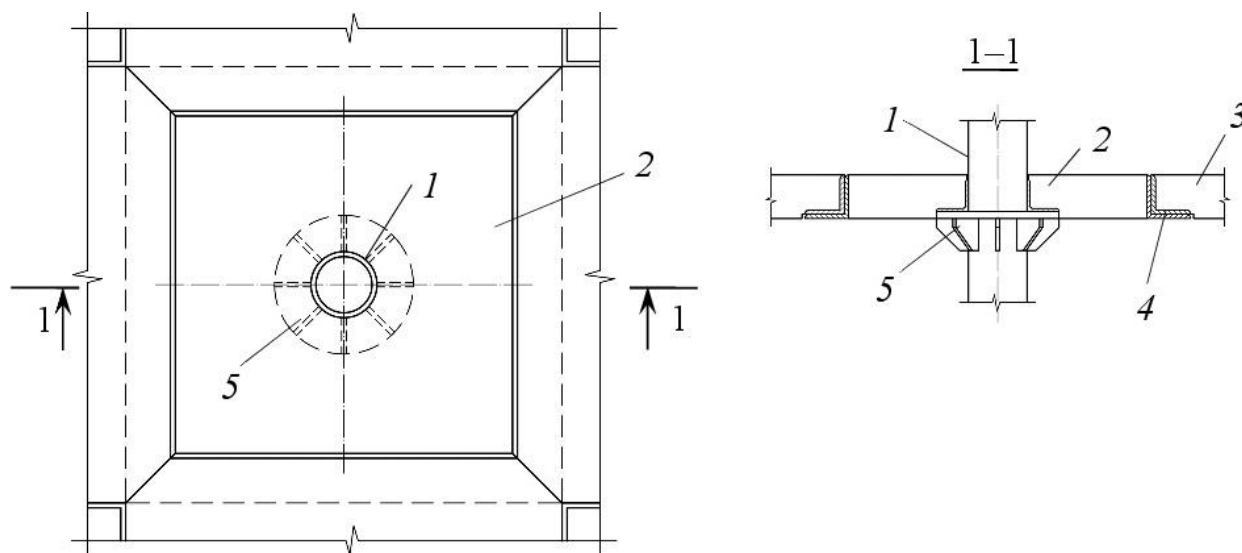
Фрагмент збірного сталезалізобетонного безбалкового перекриття: 1 – трубобетонна колона; 2 – надколонна плита; 3 – міжколонна плита; 4 – сталеве обрамлення; 5 – консоль
